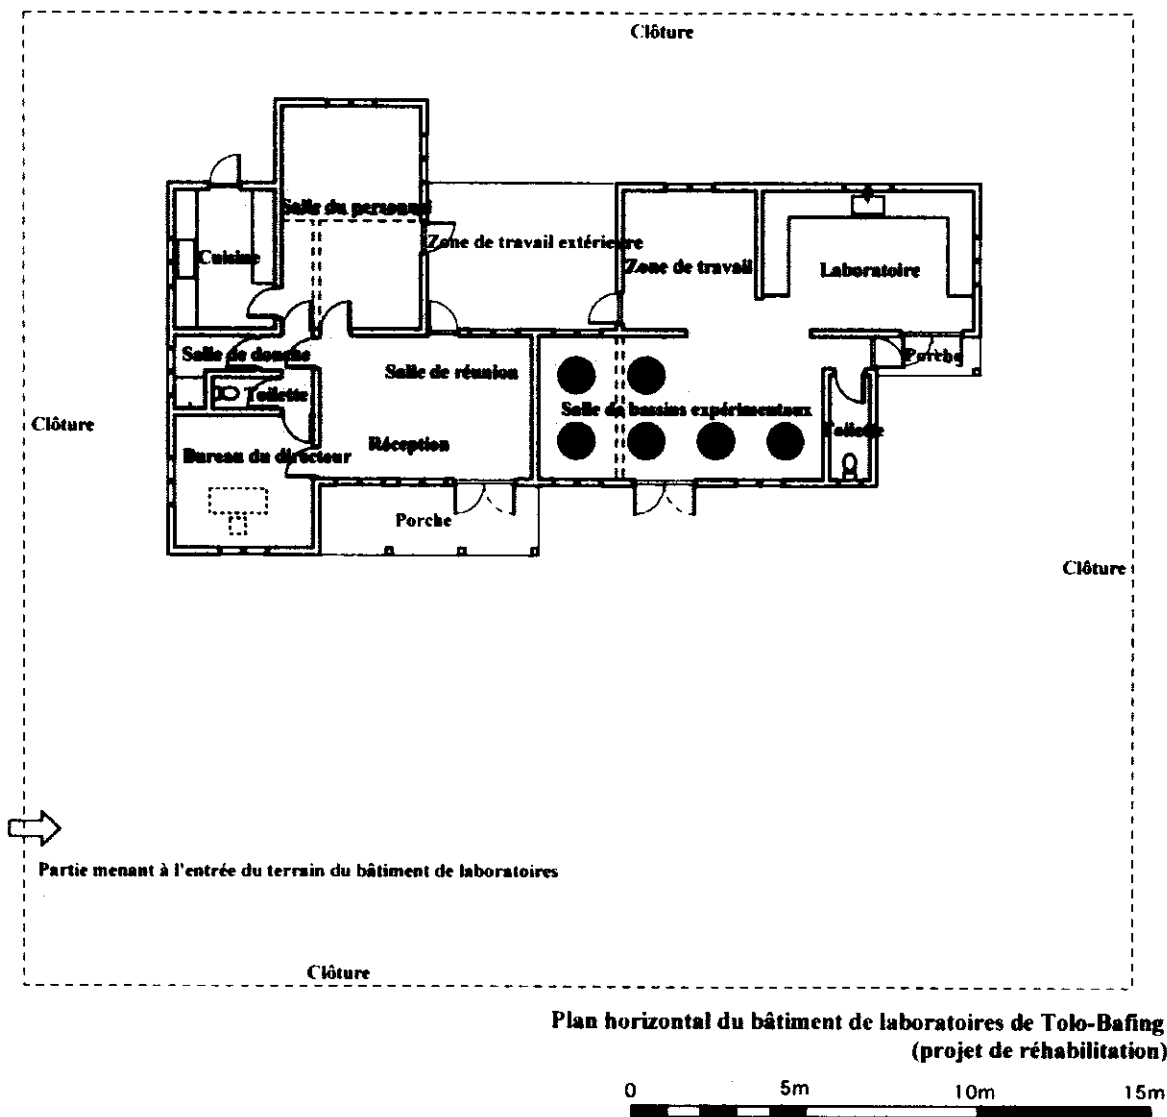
Plan horizontal du bâtiment de laboratoire de Tolo-Bafing
